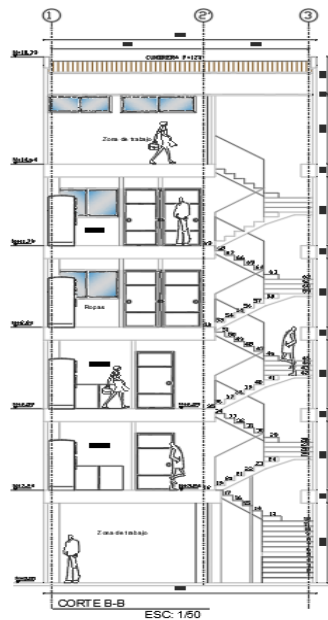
Plano estructural final del proyecto La Universidad – Faustino elaborado en AutoCAD.
